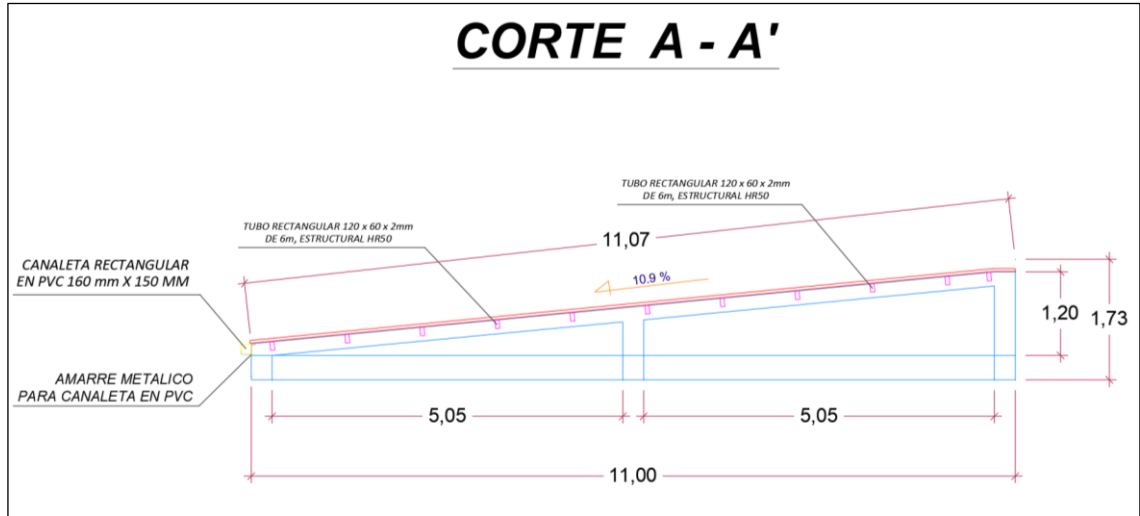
Corte arquitectónico A-A, de la estructura 4 del Centro de Desarrollo Infantil.
